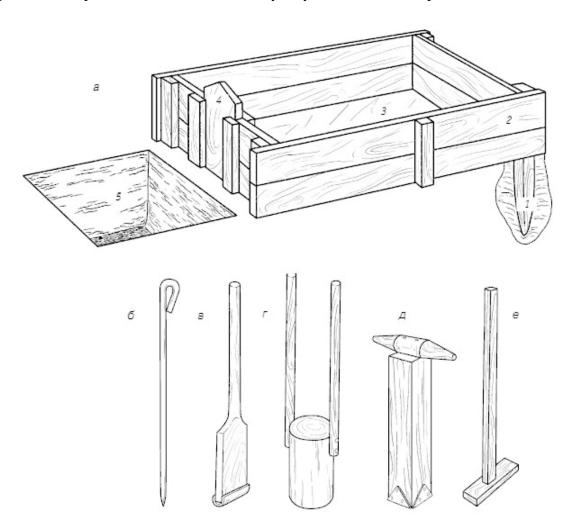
Приспособления и инструменты для приготовления и укладки бетона: а — ящик для приготовления бетона; 1 — колышек; 2 — доски; 3 — листовое железо; 4 — шибер; 5 — яма для отходов; б — щуп для шурования; в — узкая трамбовка с металлической обивкой; г — круглая трамбовка с двумя ручками; д — квадратная трамбовка с металлической обивкой; е — гладилка для разравнивания бетона
